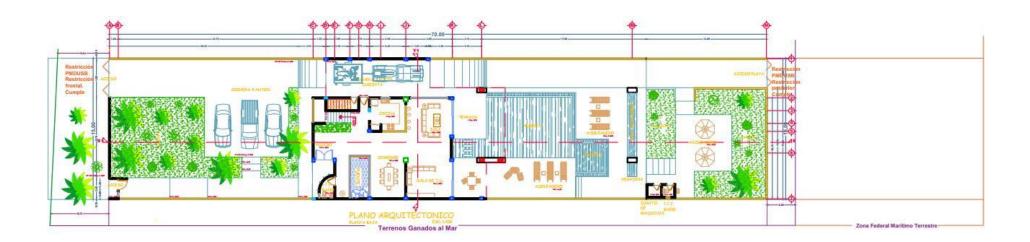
Diagrama general del proyecto a construirse (planta baja)
